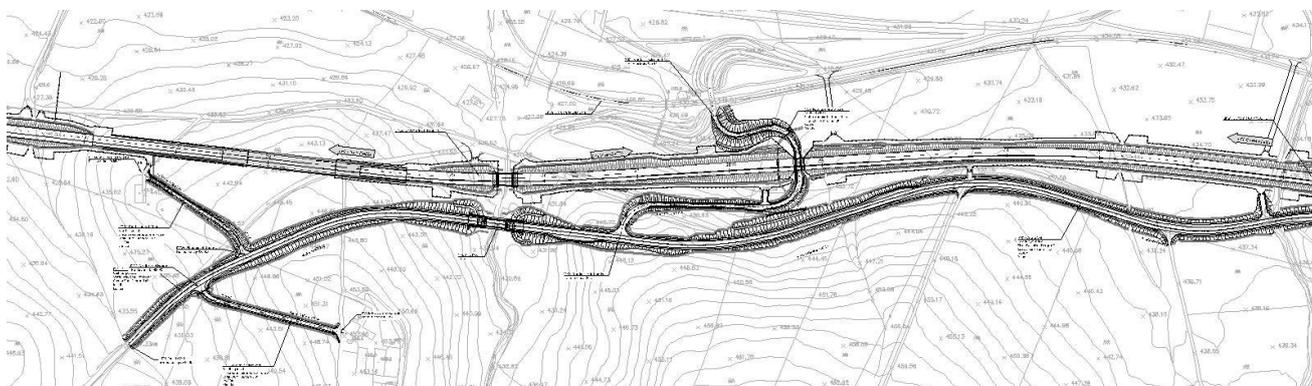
NV01 stralcio planimetrico da km 0+000 a km 1+300
